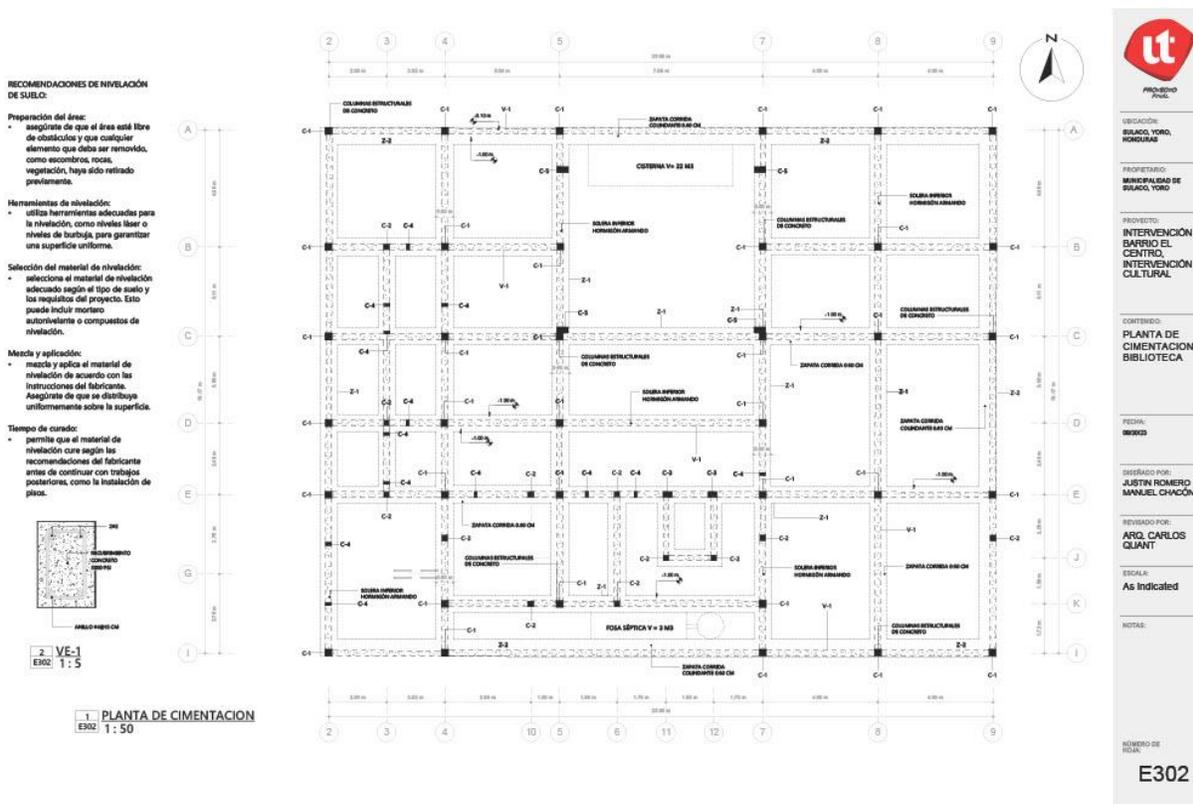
Planta de Estructura Cimentación | Fuente: elaboración Propia
